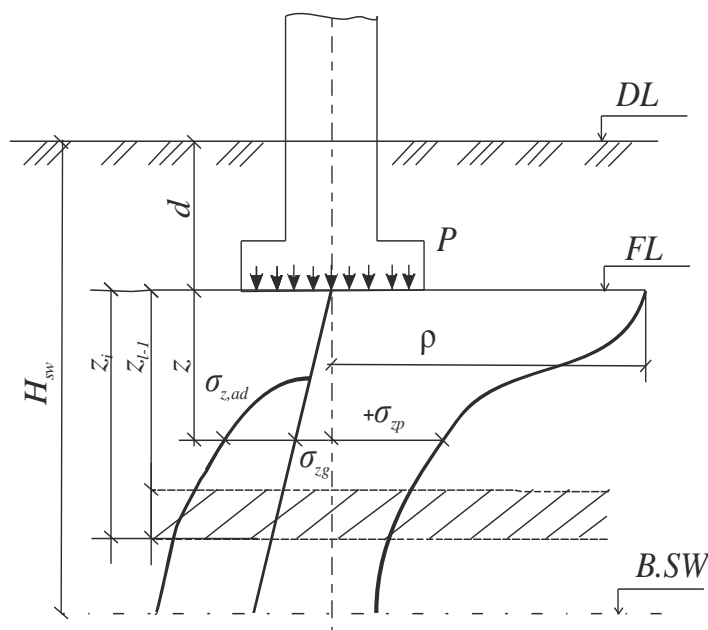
Расчетная схема к определению подъема основания при набухании грунта
